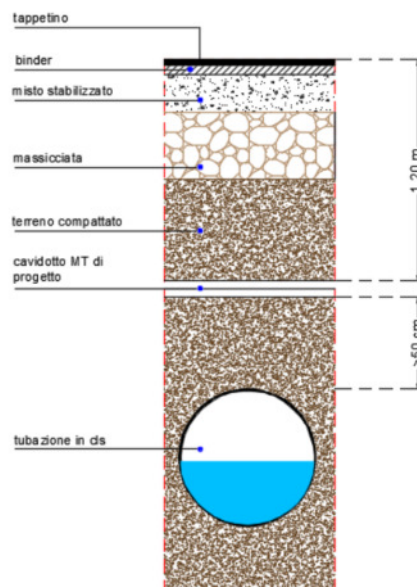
Schema tipologico di risoluzione dell'interferenza che prevede il passaggio del cavidotto sopra l'opera di canalizzazione e nel pacchetto stradale (Rif. FV.ALC0.PD.G.02)
